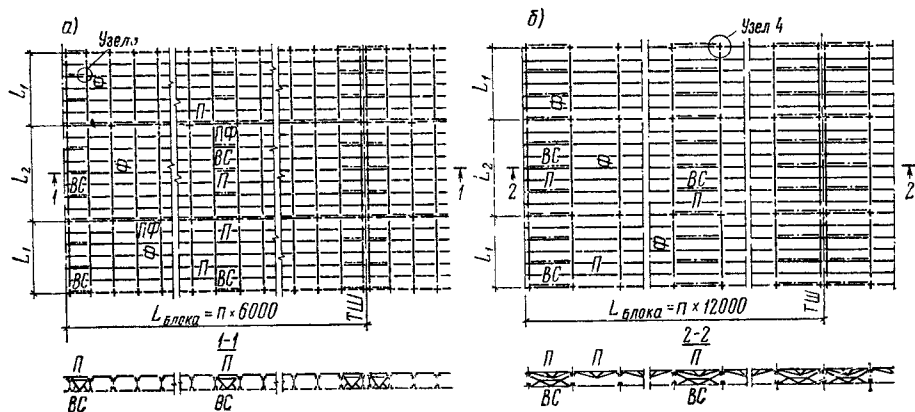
Схемы расположения элементов конструкций покрытия в уровне верхних поясов ферм при применении стального профилированного настила при прогонной схеме
